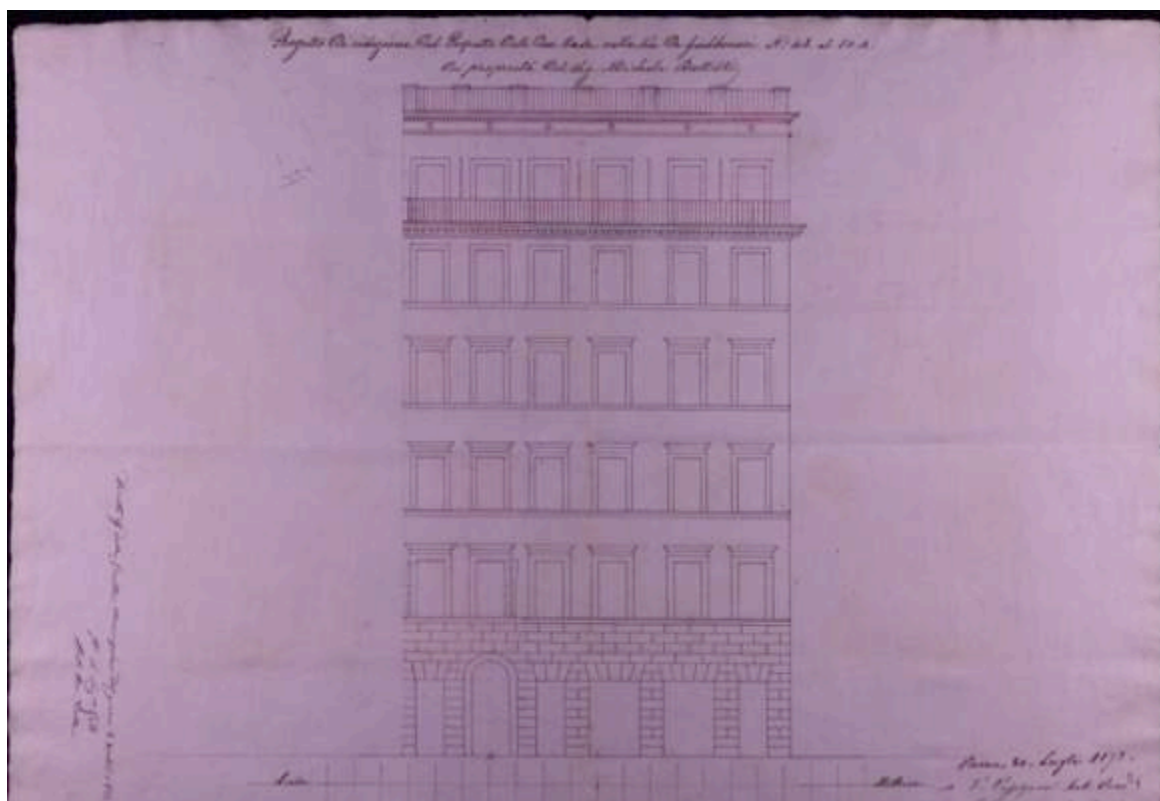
Progetto di riduzione del prospetto di via dei Giubbonari 46-50 a, 1879, Roma, Archivio Storico Capitolino, tit. 54, 1871-1922, pr. 69517/1873
